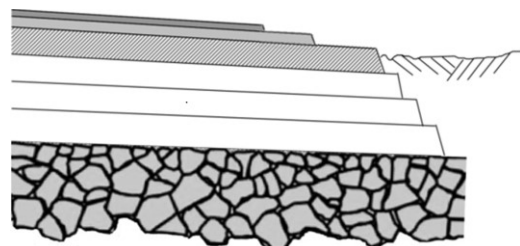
Randverharding met uitstroomconstructie en trapsgewijs afgebouwde tweelaags ZOAB deklaag
